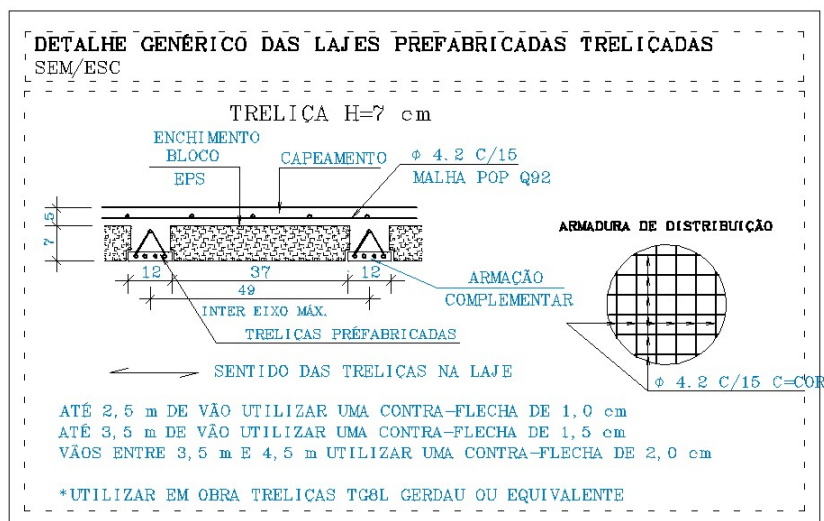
Detalhe típico das lajes treliçadas prefabricadas.
